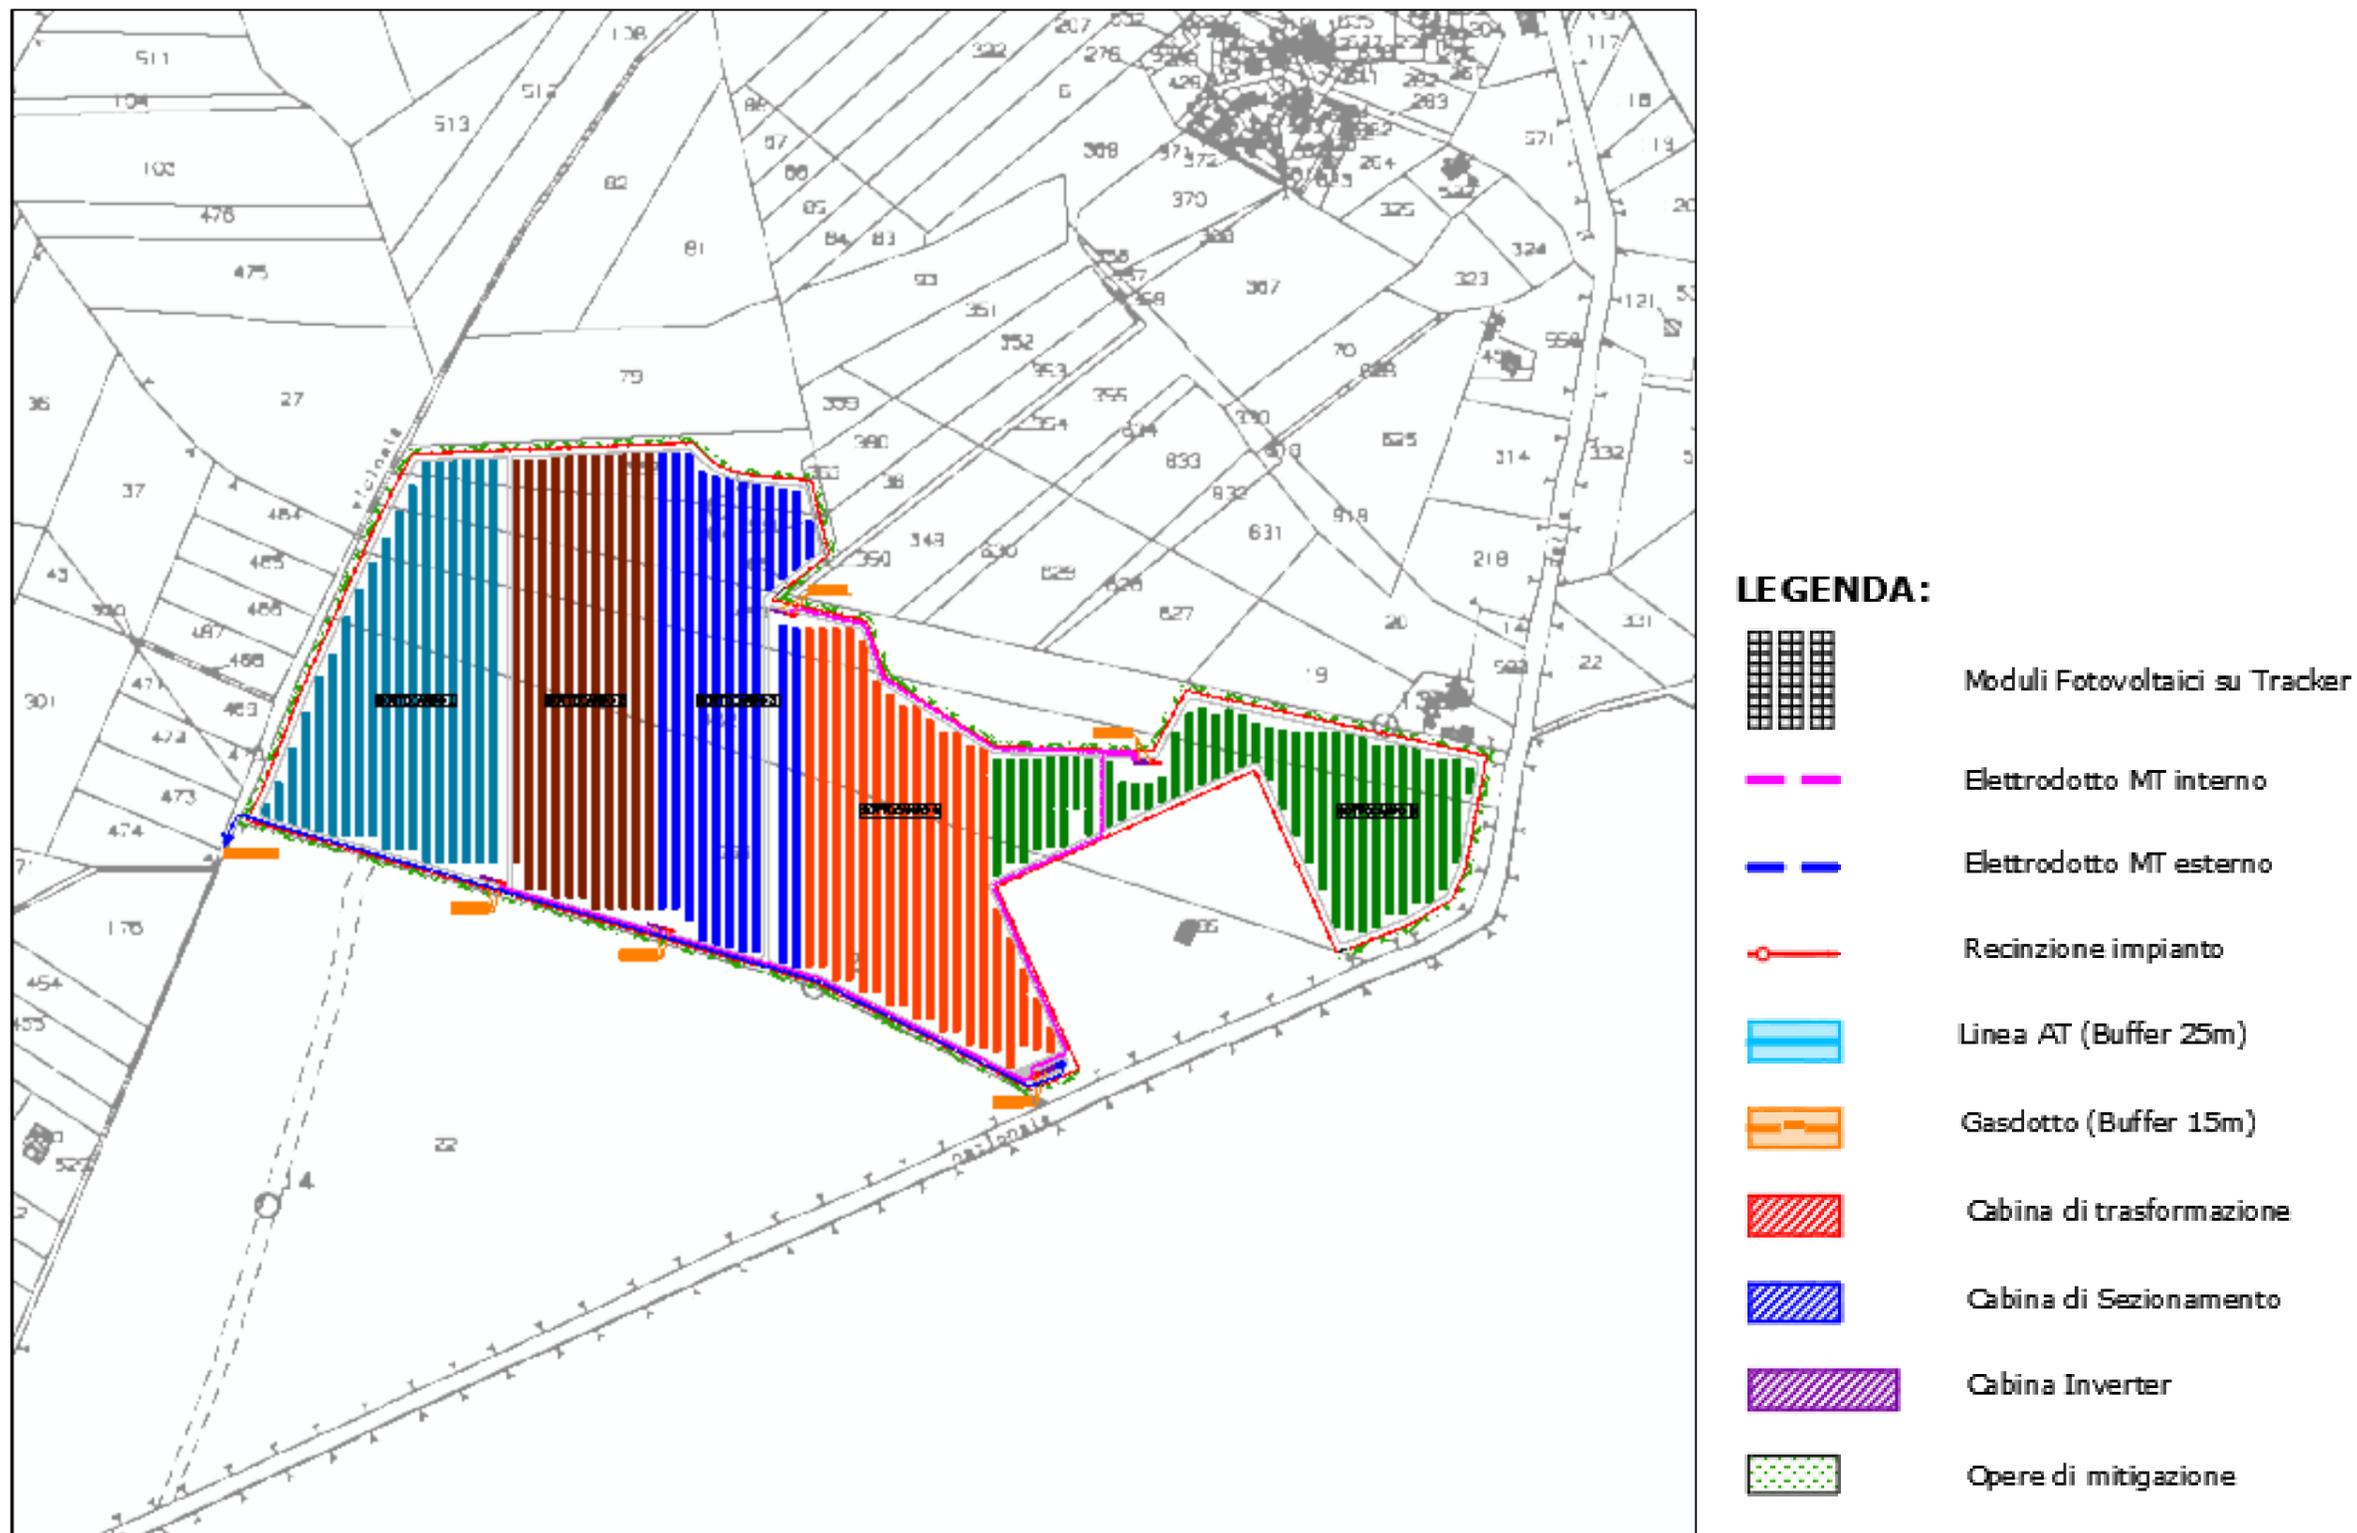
Stralcio elaborato DEF-TAV.07 – Layout impianto con sottocampi
